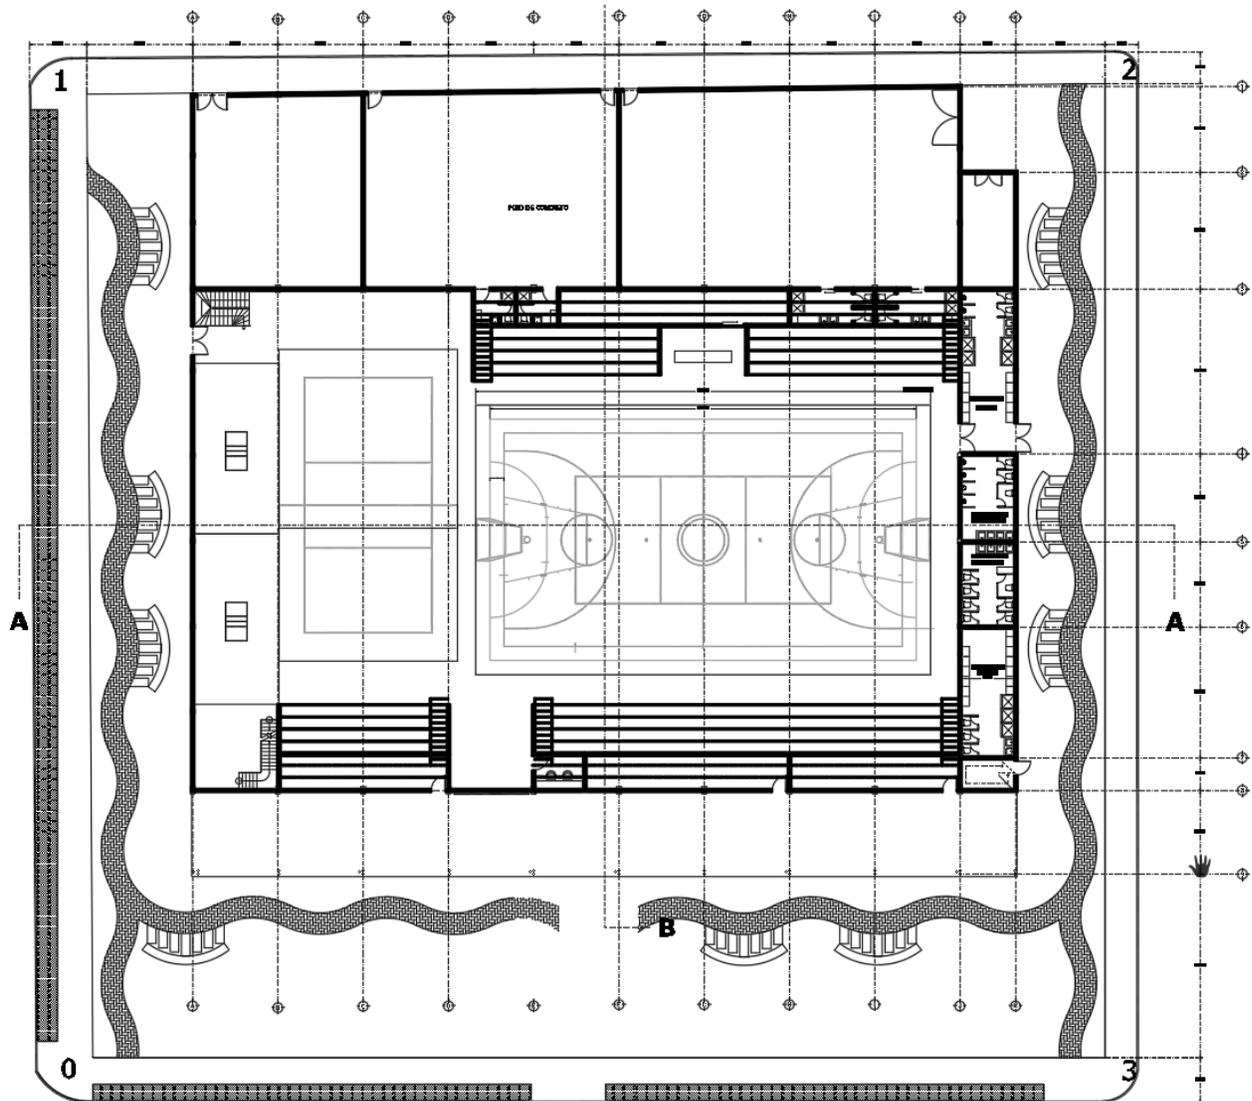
Propuesta final Planta Arquitectónica Nivel1, Palacio de los Deportes
